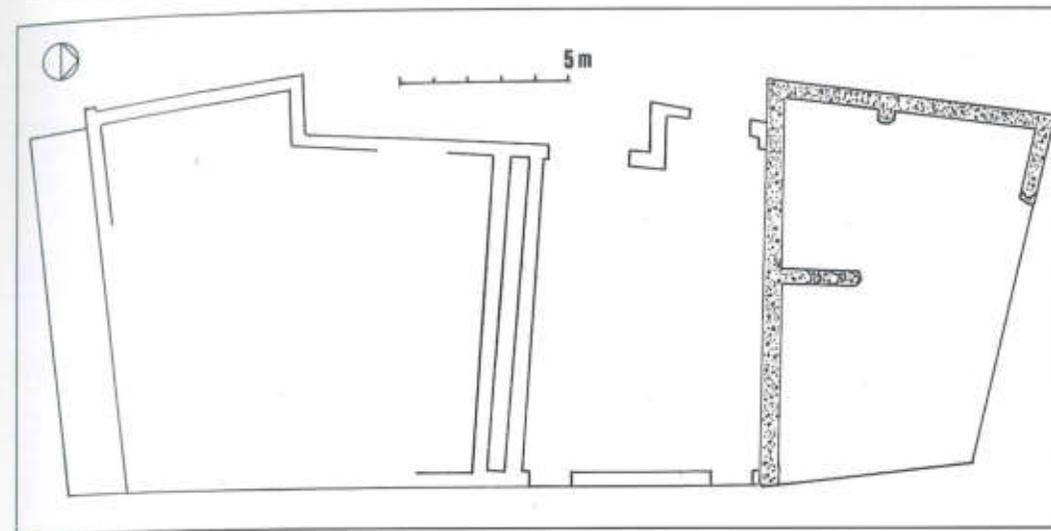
/ Sovrapposizione dello schizzo planimetrico dell'edificio preso in esame (evidenziato in grigio) su pianta del 1908 (elaborazione dell'autrice).
